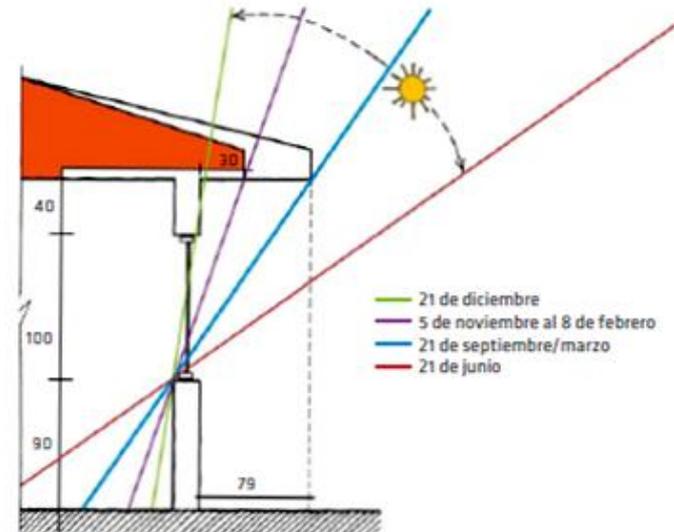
Dimensionamiento de protección solar horizontal norte para latitud 33° (Santiago).
